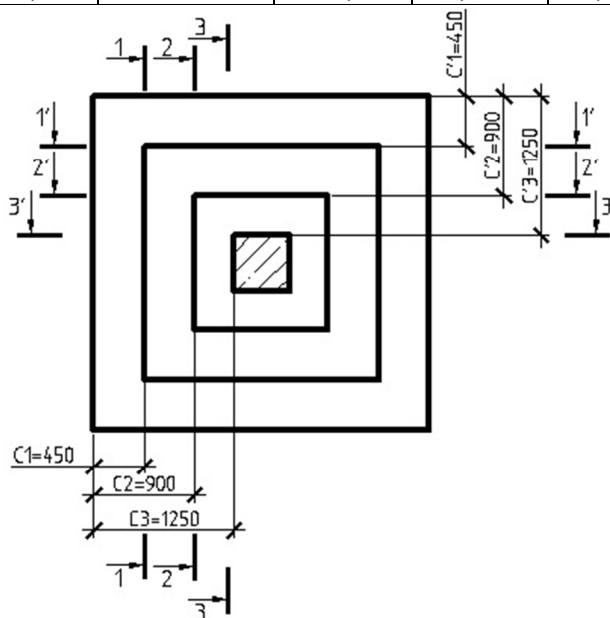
Схема к расчету арматуры плитной части фундамента
